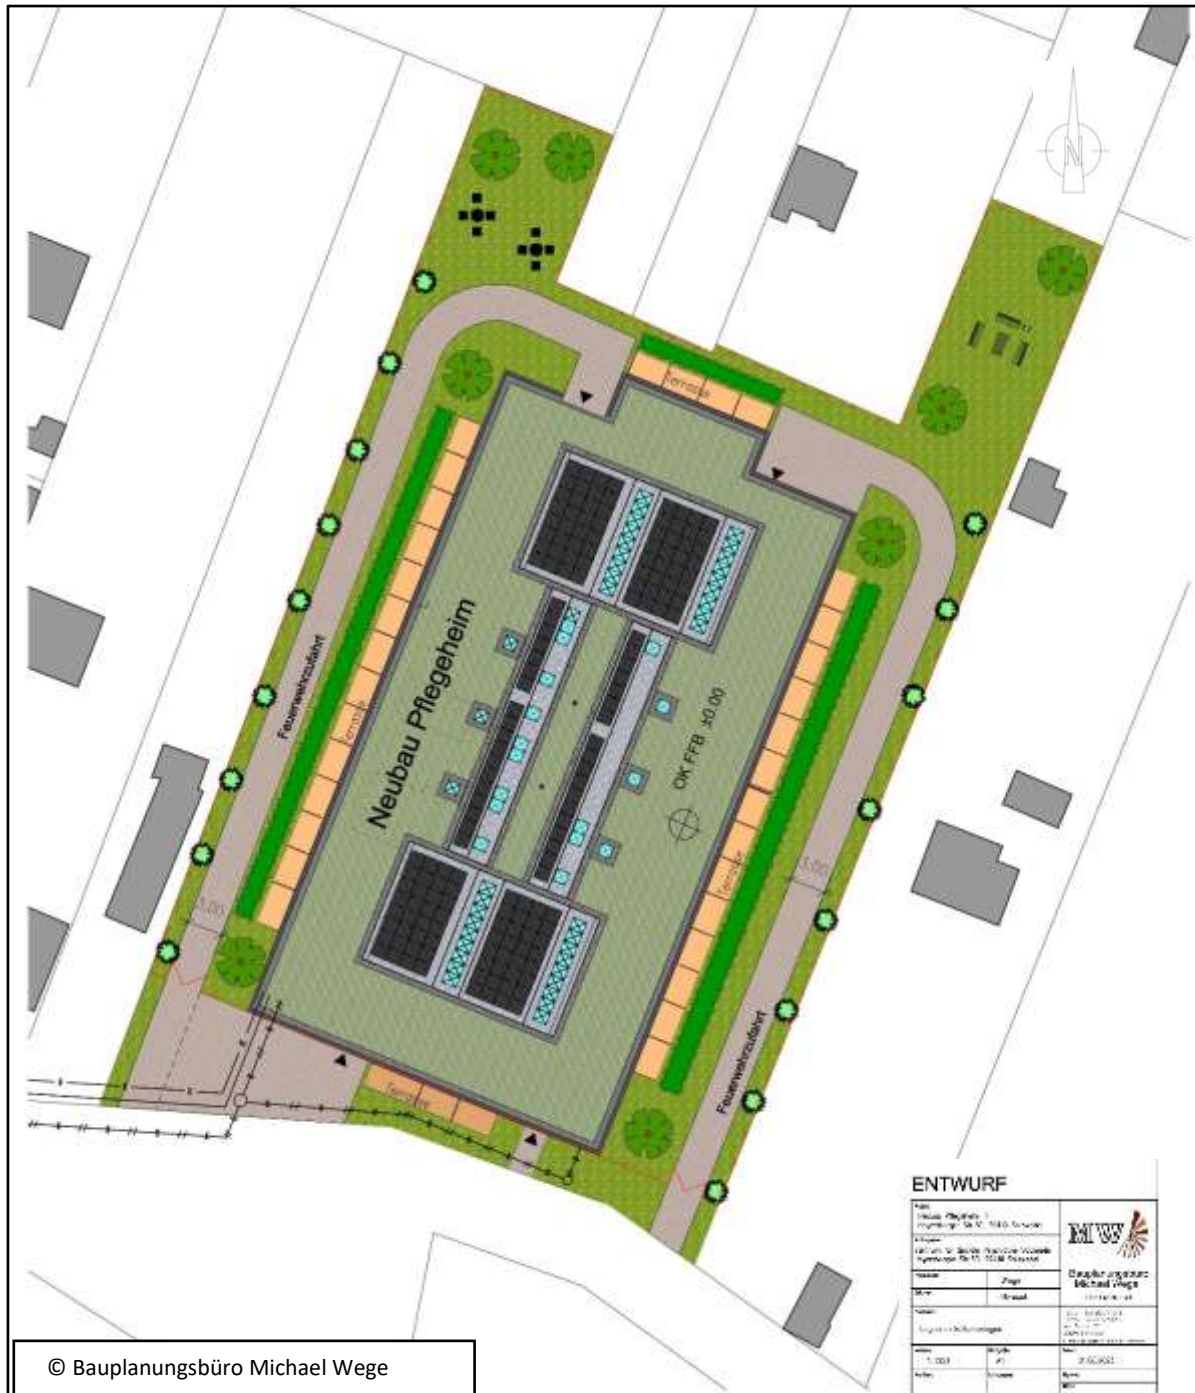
Lageplan des Pflegeheim-Neubaus mit Außenanlagen.
